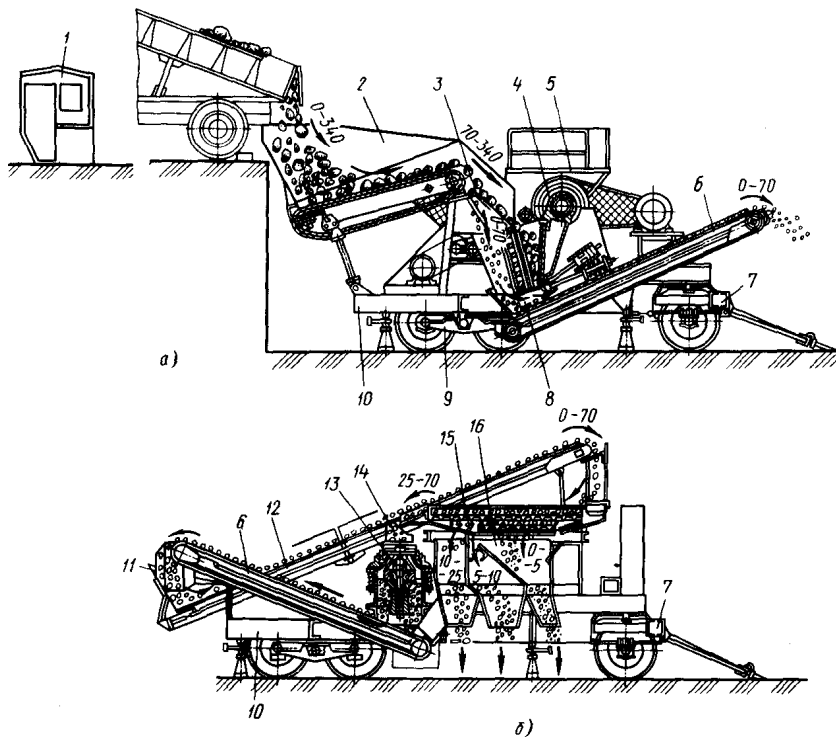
Схема агрегатов первичного и вторичного дробления передвижной установки: а – агрегат первичного дробления СМД-126; б – агрегат вторичного дробления СМД-127.
